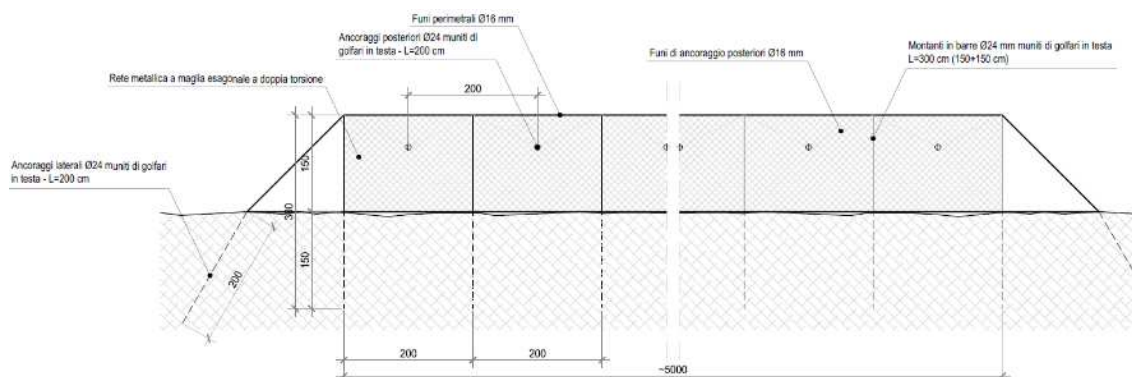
stralcio grafico del prospetto tipologico della rete di presidio (v. disegno D08)
